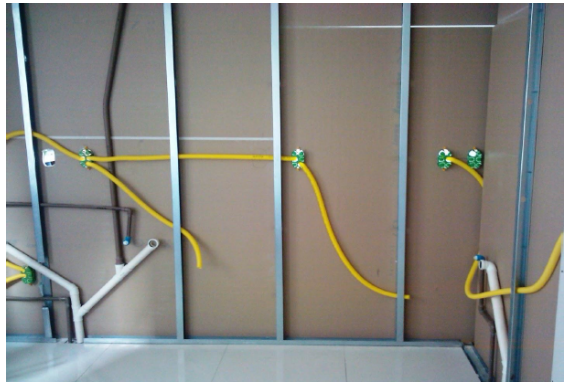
Parede hidráulica utilizada em uma construção modular.
